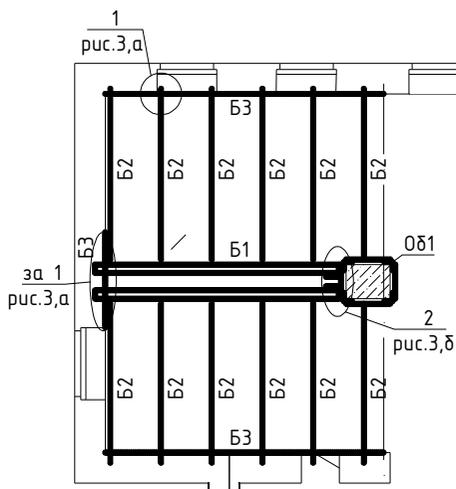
Фрагмент розкладки сталевих балок нового СЗБ перекриття
